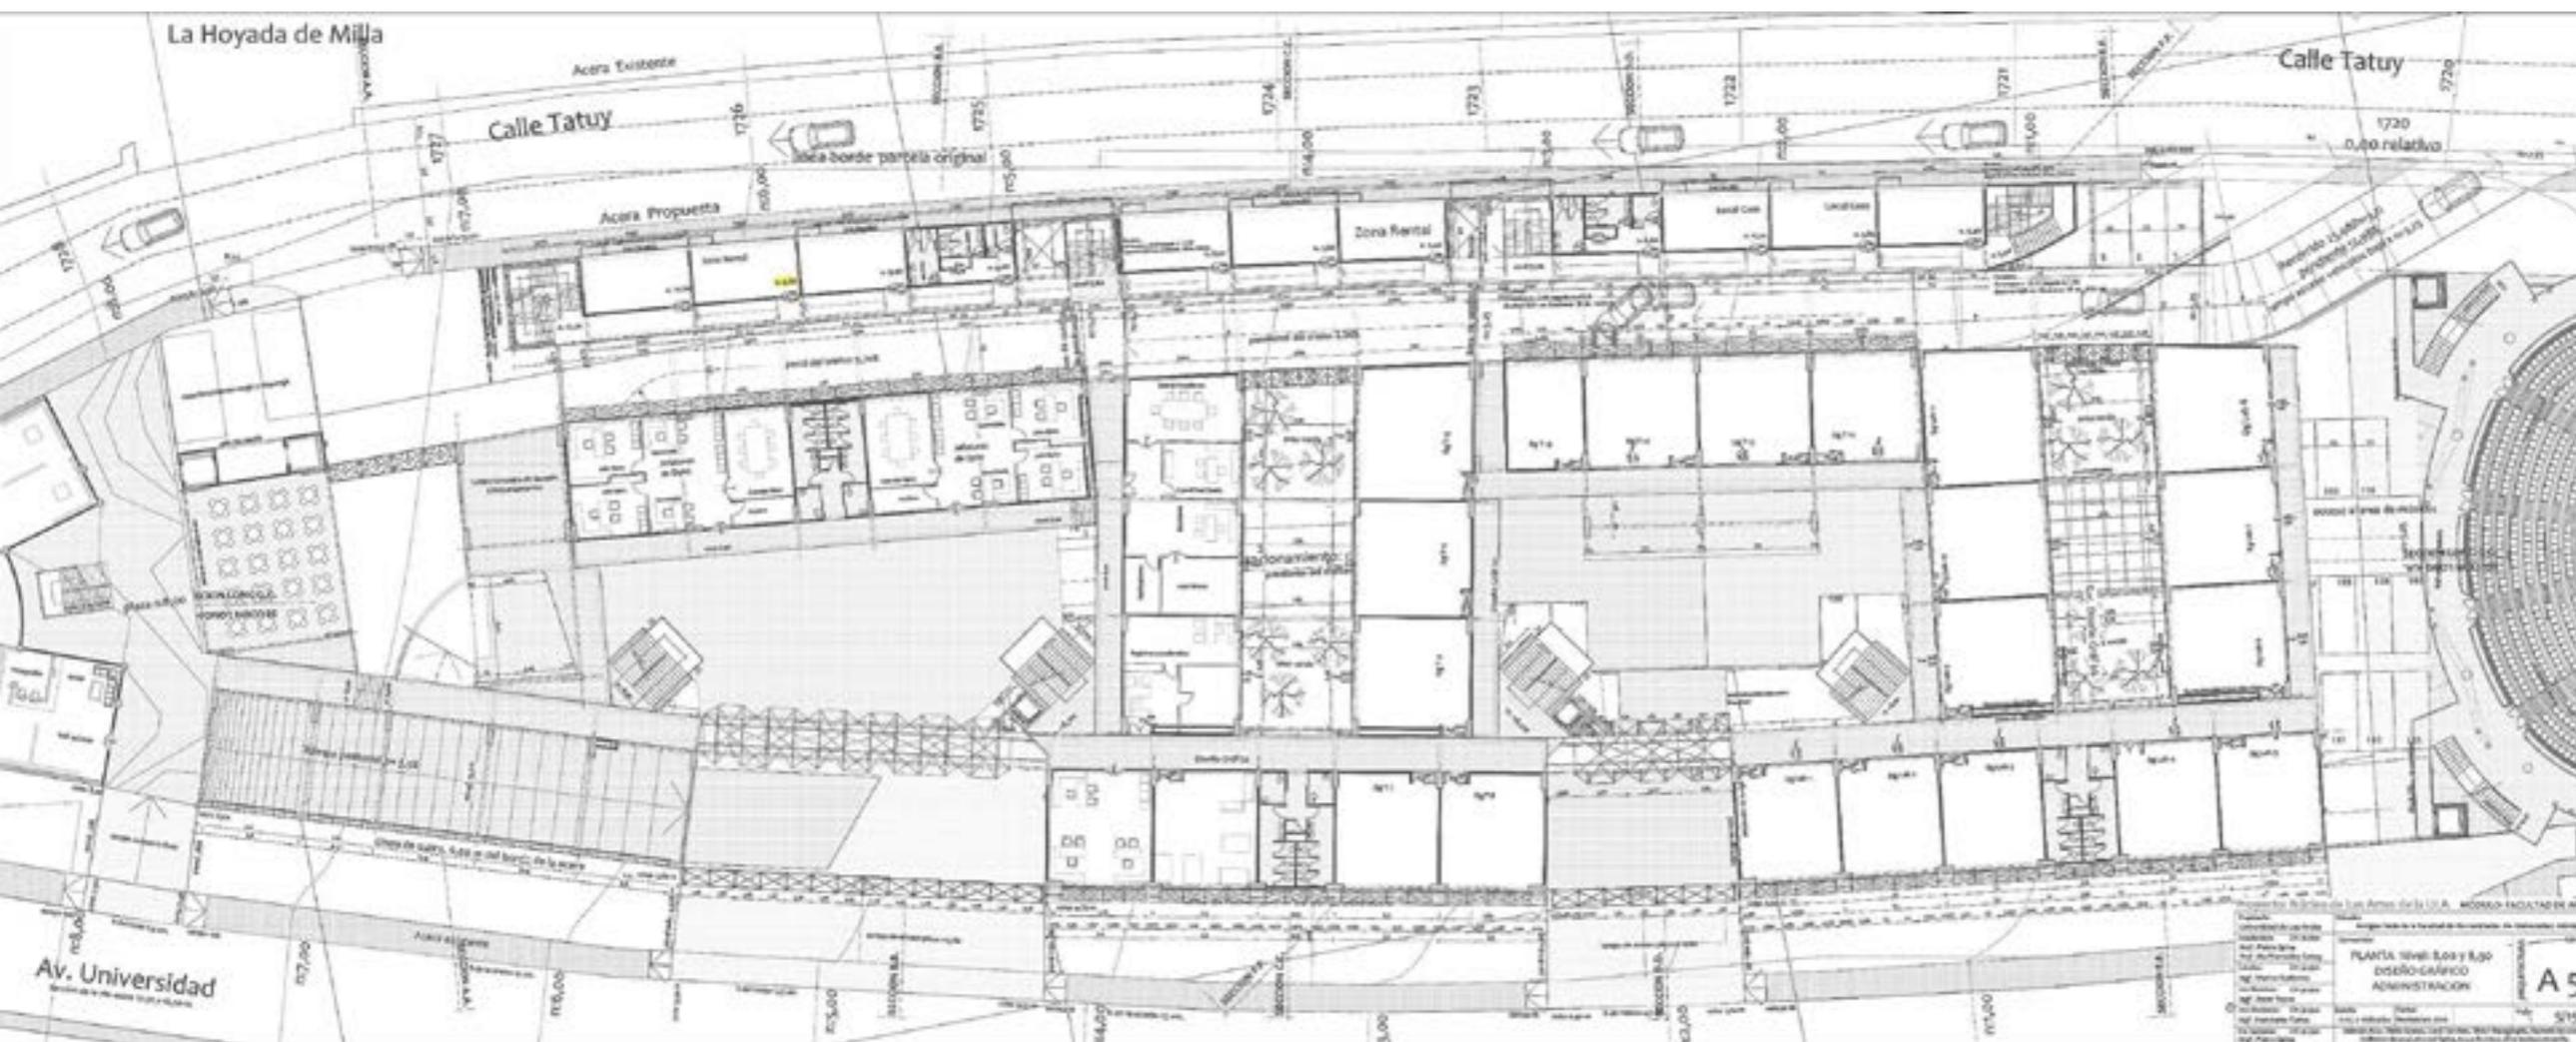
Planta de conjunto del nivel 8.00 con vistas incorporadas
